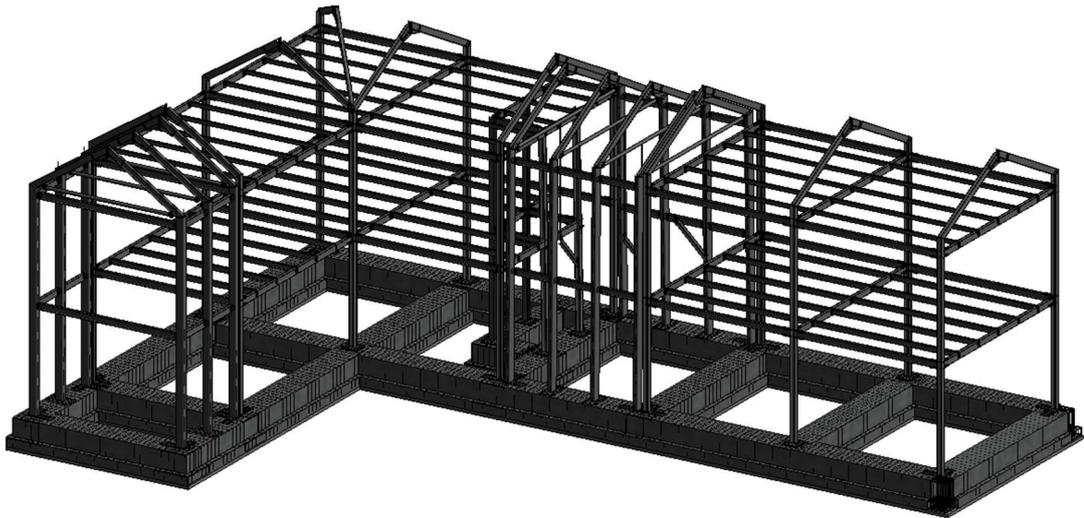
Rappresentazione 3D delle strutture di fondazione e in elevazione dell'edificio
